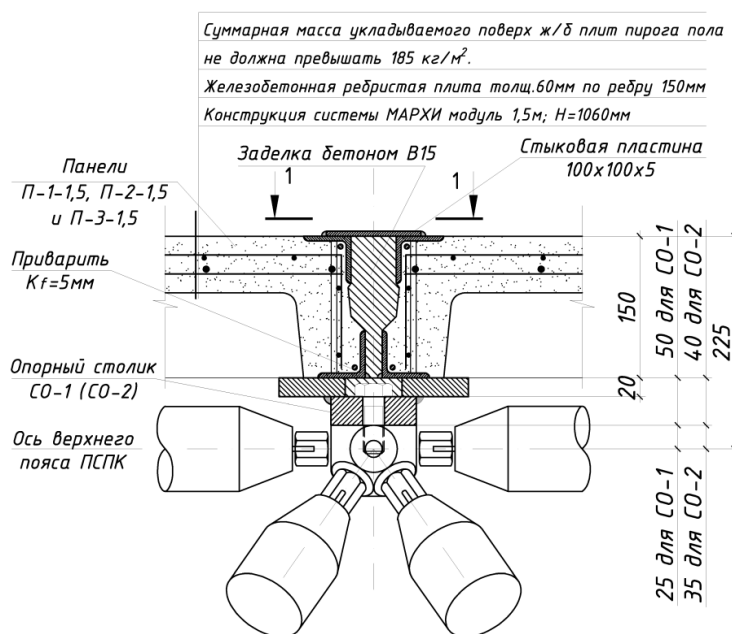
Принципиальная схема прикрепления железобетонных плит к ПСПК через стальной монтажный столик
